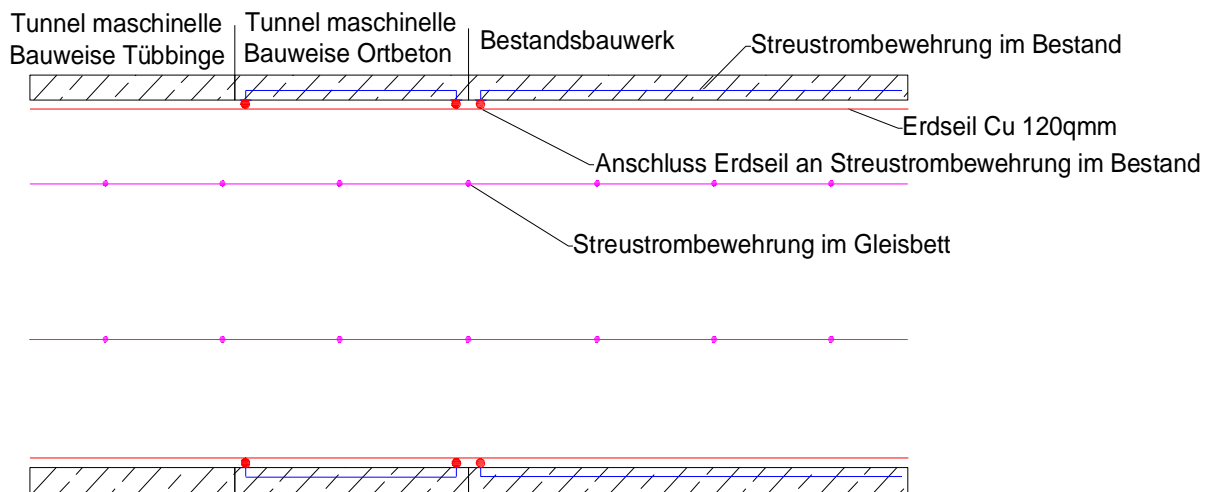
Anschluss Tunnel maschinelle Bauweise an Bestand (Grundriss)
